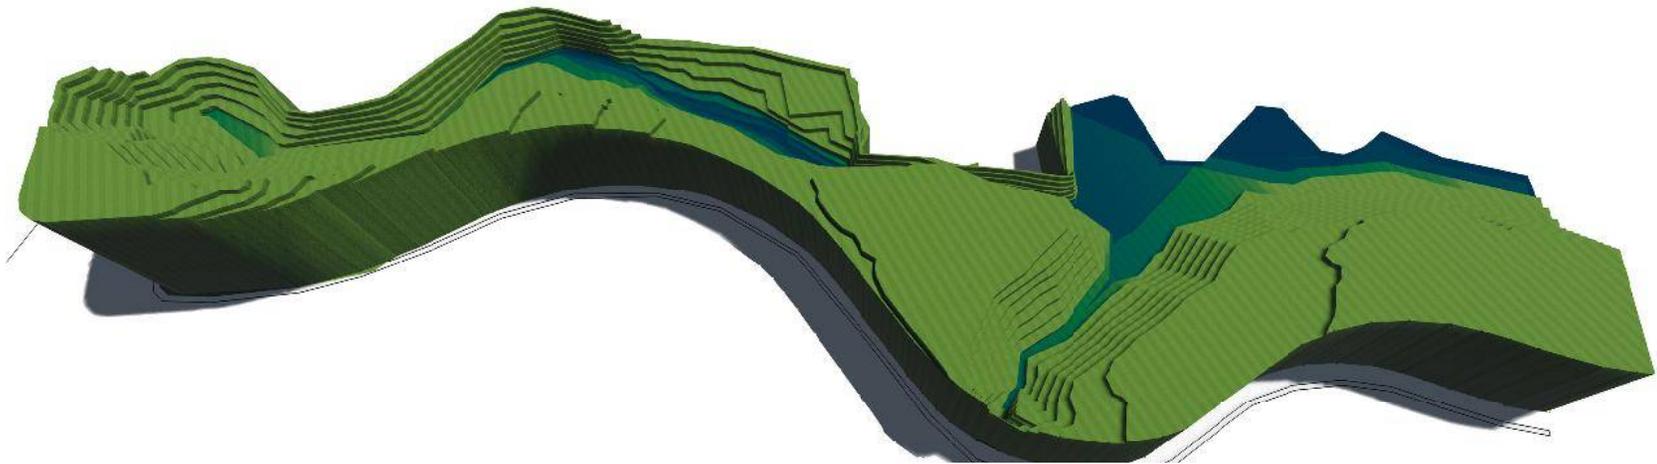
Vista Sur del Terreno Parque Alejandría
